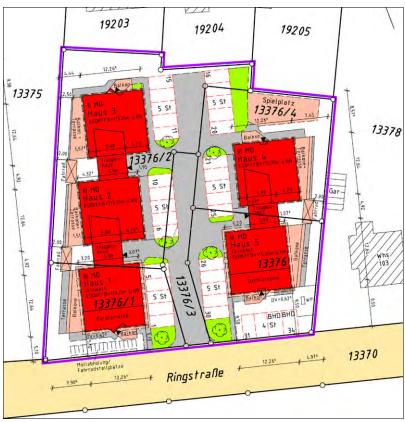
Lageplan Vorhaben- und Erschließungsplan
